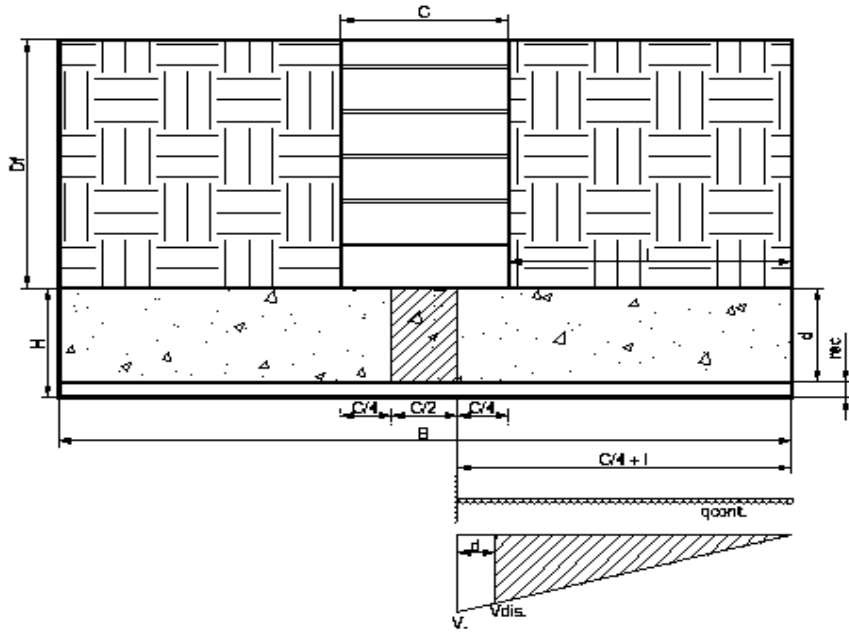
croquis para el diseño estructural de una zapata corrida central.
